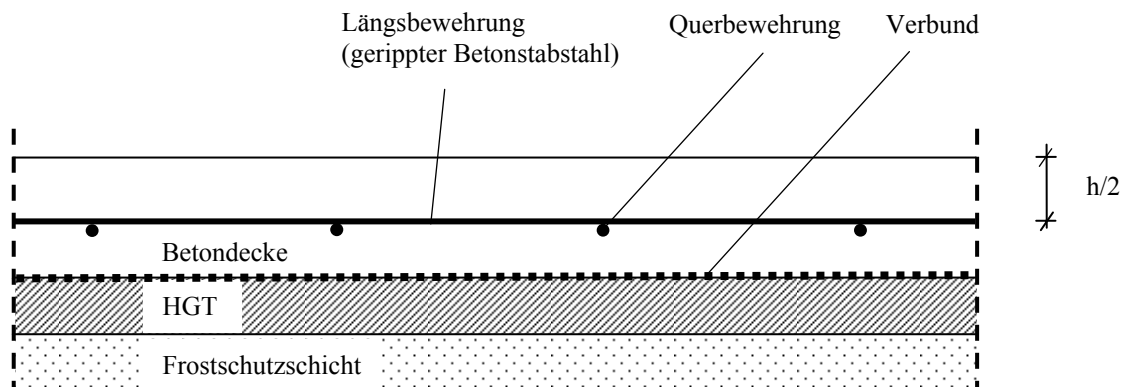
Möglicher konstruktiver Aufbau einer durchgehend bewehrten Betondecke übertragen auf die Verhältnisse in Deutschland
